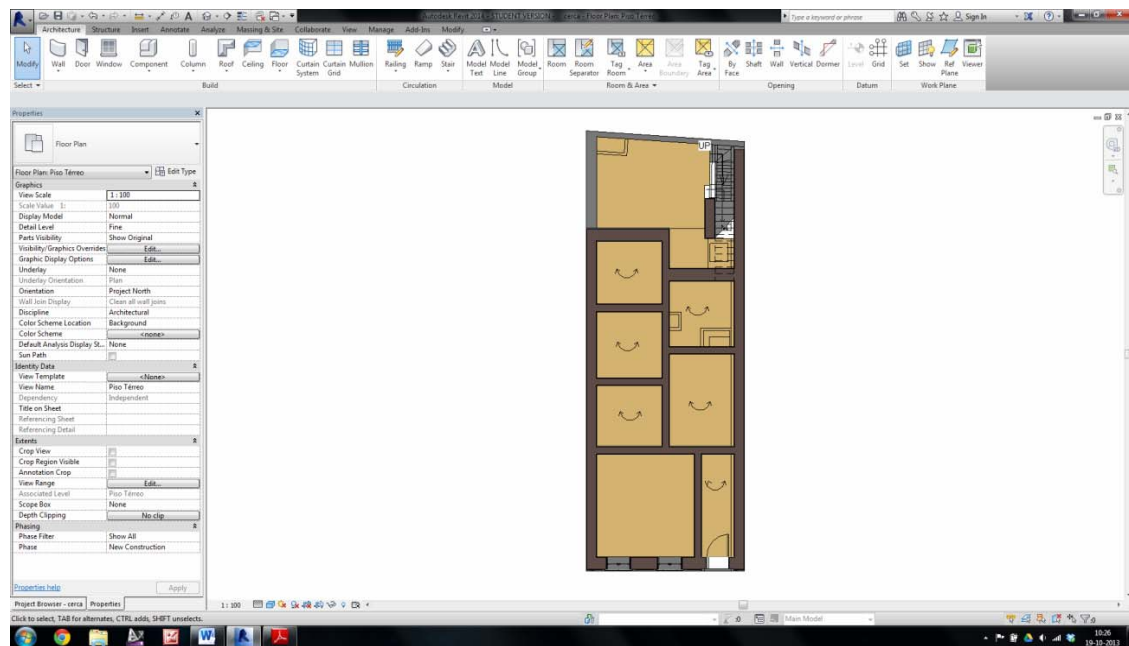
Planta de distribuição das divisões da habitação tipo “Cerca”.
